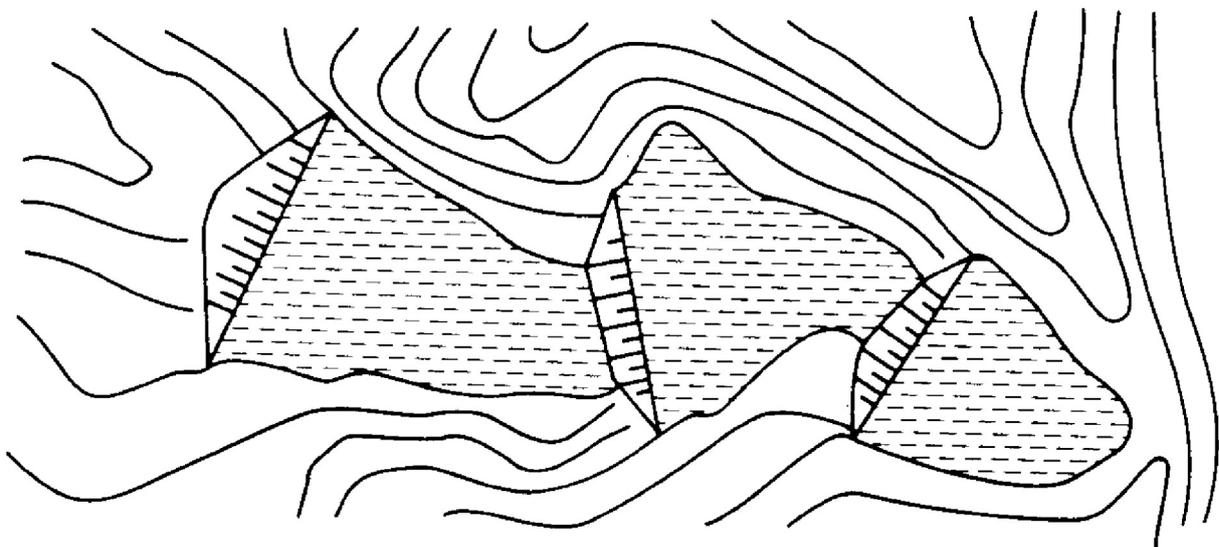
Barragens construídas em vale, em cascata (VICK, 1983).
